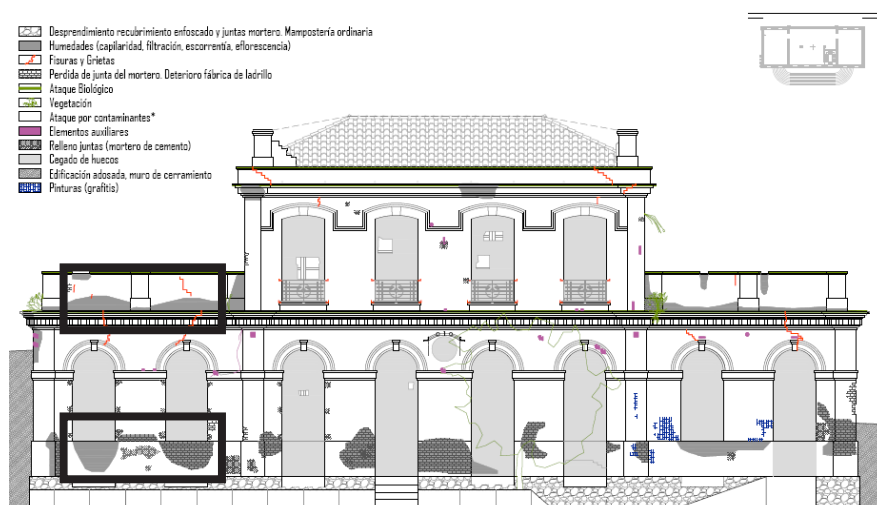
Imagen XI-II. Filtración del agua de lluvia. Fachada calle Cuatretonda. Fuente: Propia.
